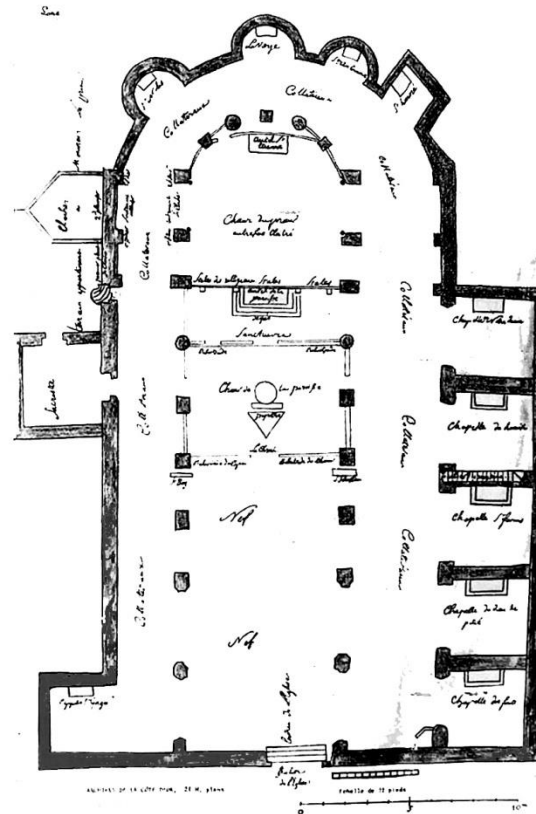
Plan de Notre-Dame de Losne AD Côte-d'Or 21 H, plans.
